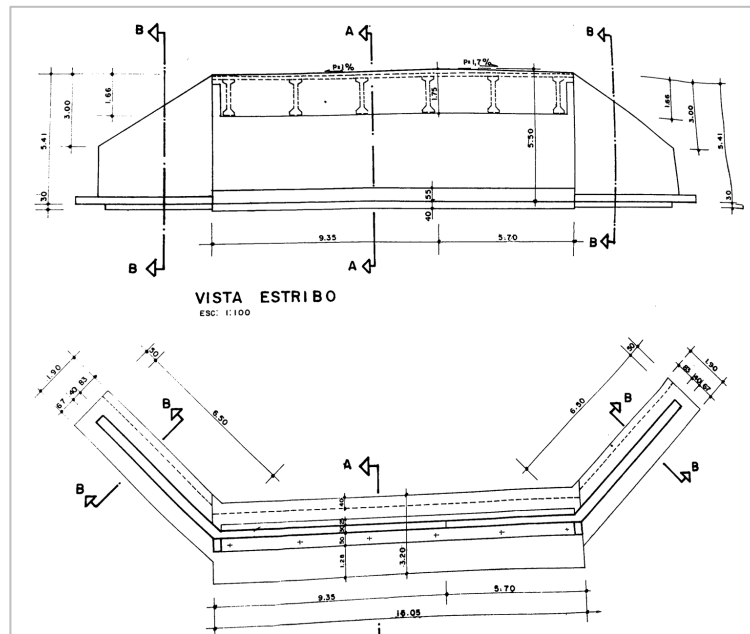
Planta y alzado de Estribos, Puente El Anís, propiedad del Ministerio Popular para el Transporte (1978).
